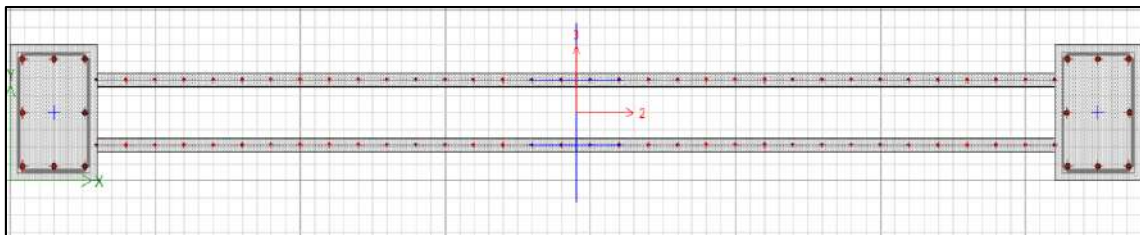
25 Ejemplo de armado de enchapes con espacio de pared, muro P3
